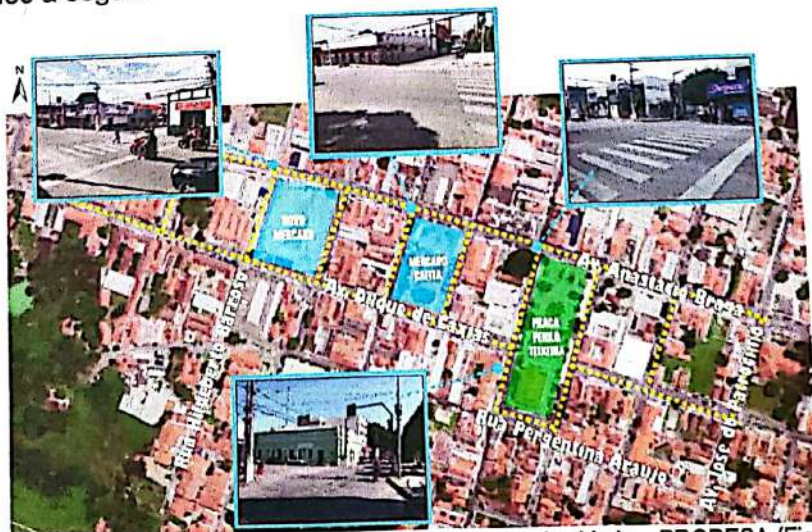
Plano de vias urbanas que deverão ser pavimentadas no centro da cidade – PRODESA (Fig. 4.10 – pág. 1691 da Proposta Técnica da CONCREMAT)
